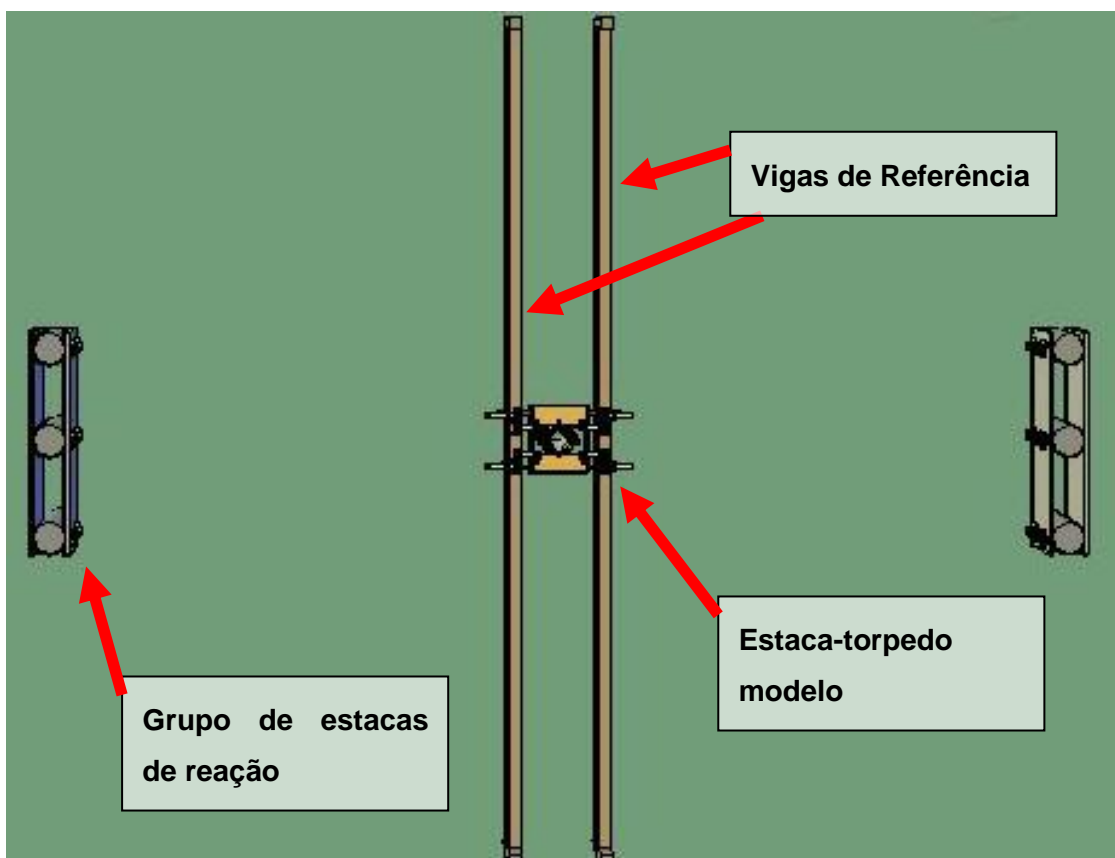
Vista em planta do posicionamento das vigas de referência
